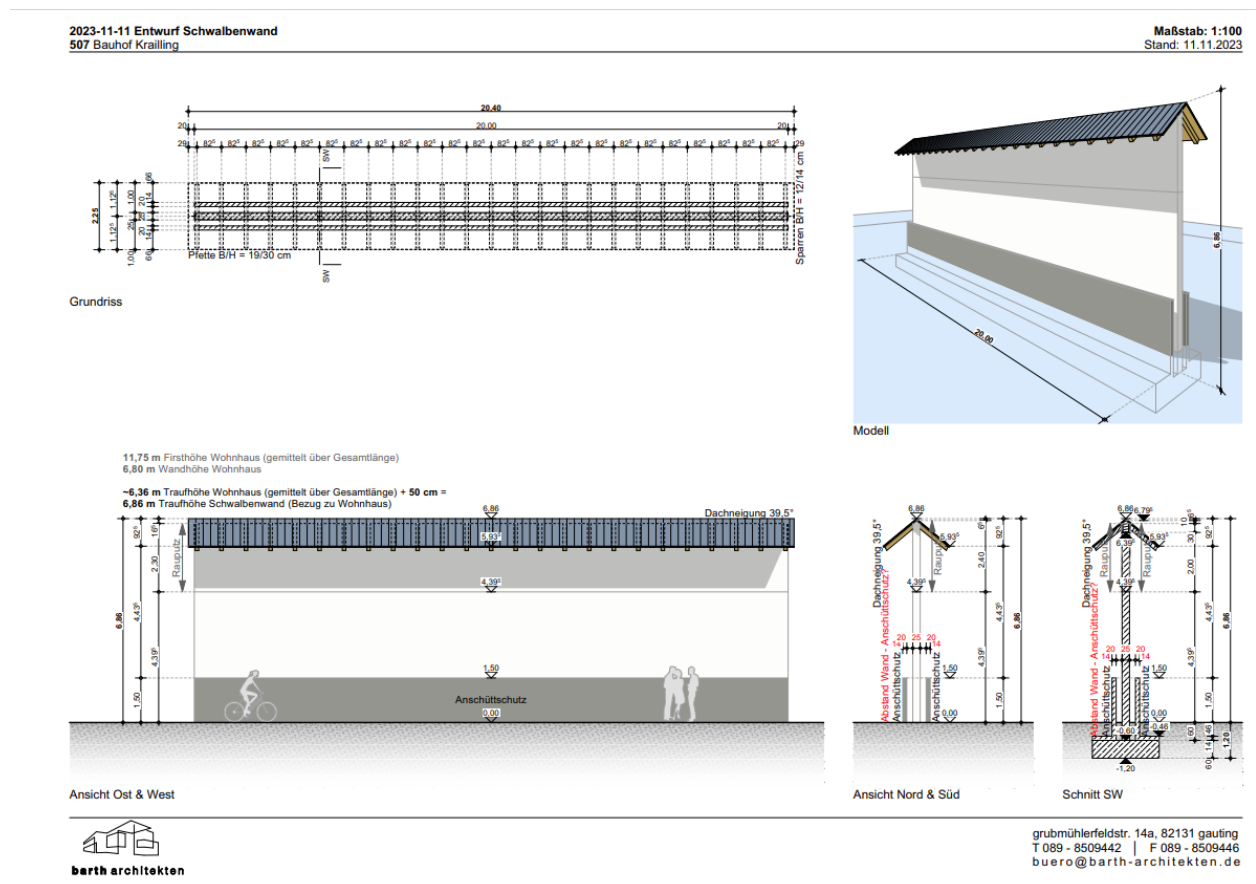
Modellzeichnung der Schwalbenwand, die ggf. die bestehende Wand zur Grüngutsammelstelle ersetzt
